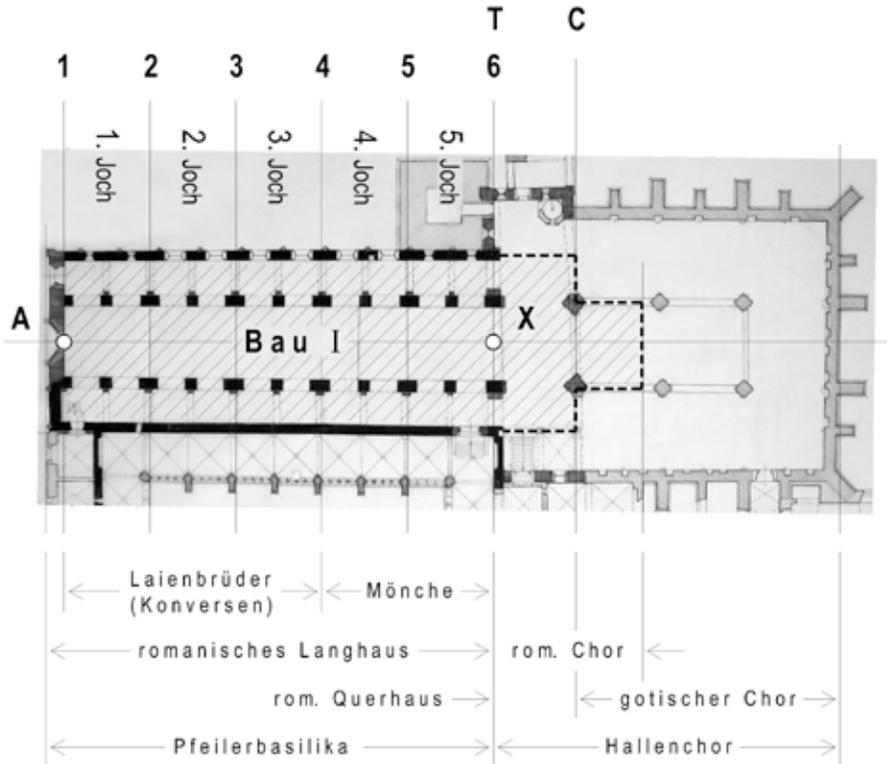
Heiligenkreuz, Stiftskirche, Grundriss, Begriffe (Hintergrundbild: Baualterplan nach A. Klaar, Bundesdenkmalamt, Architekturabteilung, Planarchiv, Inv.-Nr. 10441, aufgenommen 1966-68).
